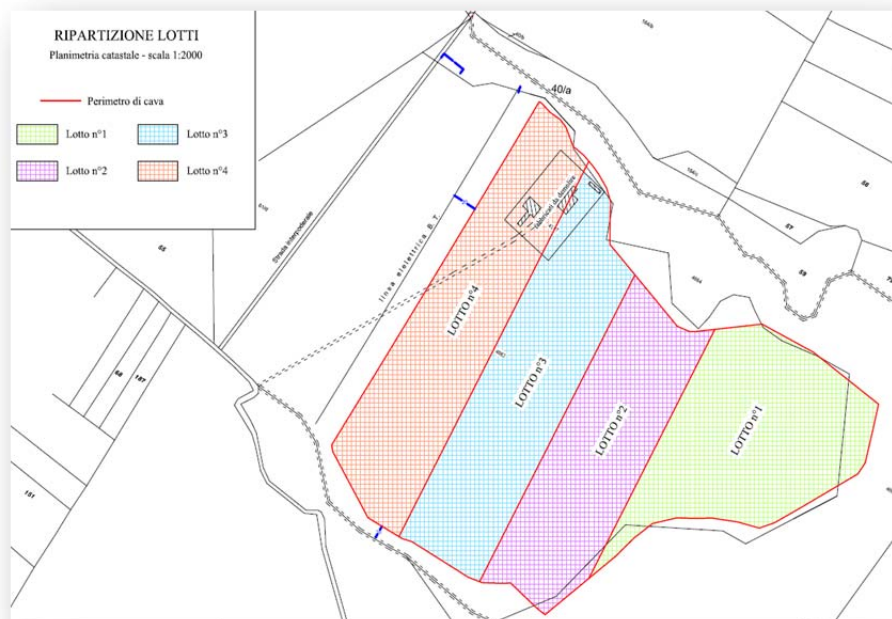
Planimetria catastale con ripartizione lotti
